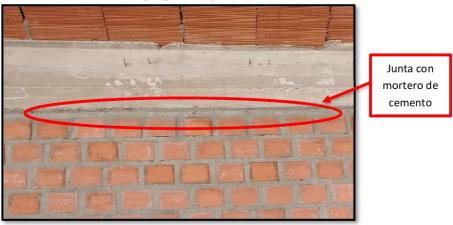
Junta entre muro y viga según planos del expediente técnico
